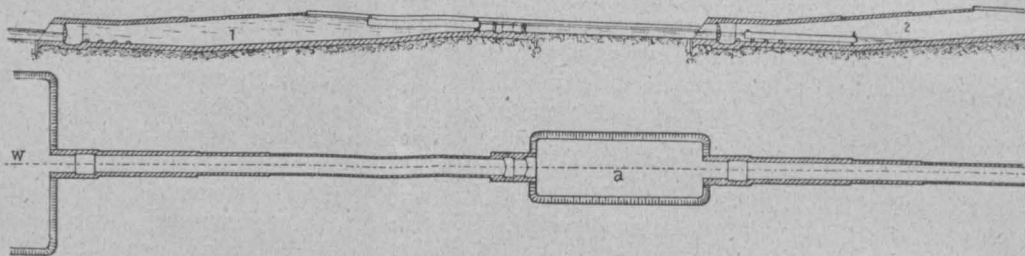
Längenschnitt und Grundriß einer Schleusentreppe mit röhrenförmigen und geneigten Schleusenkammern
